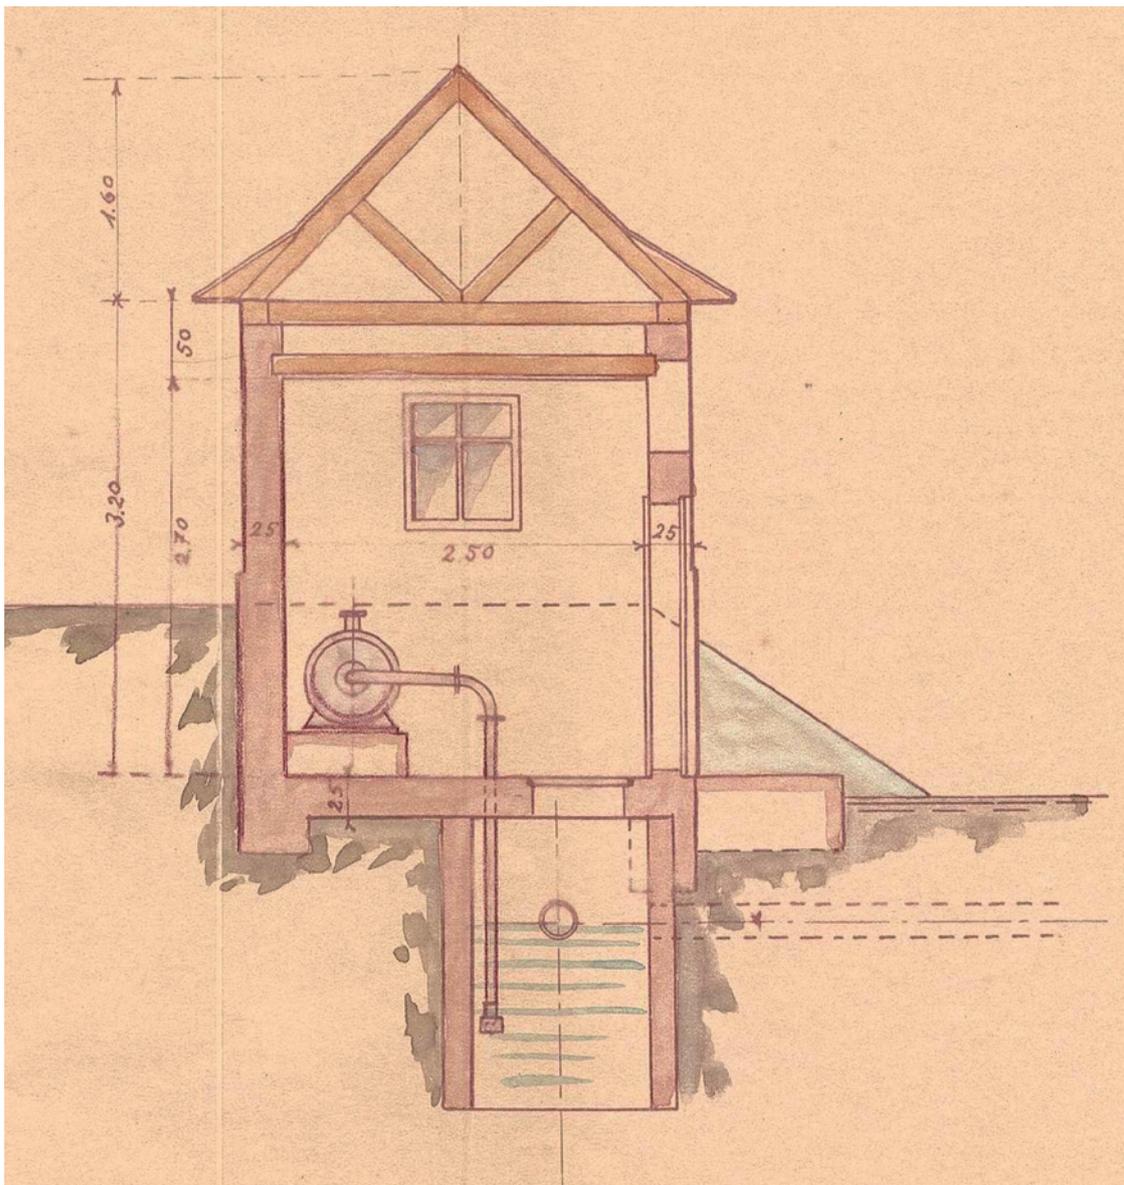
Schnitt Grundwasserpumpwerk "Wäschhütle", Plan von 1932
